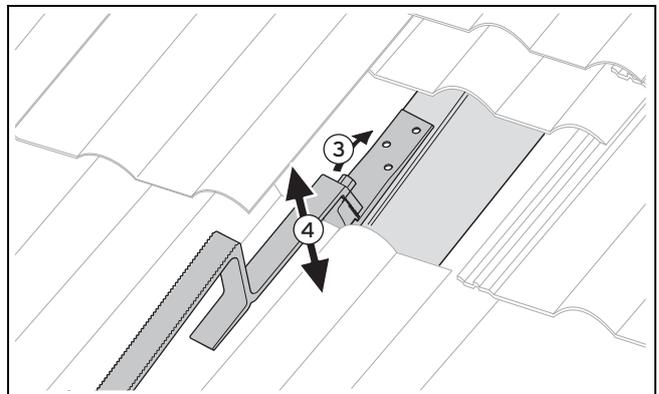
Dachanker Typ P auf dem Dachsparren korrekt positionieren
